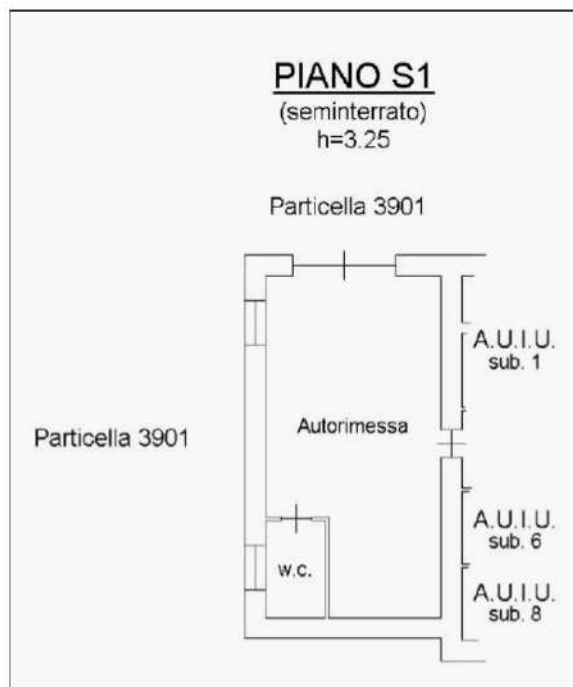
Planimetria catastale autorimessa comune (sub.2)
